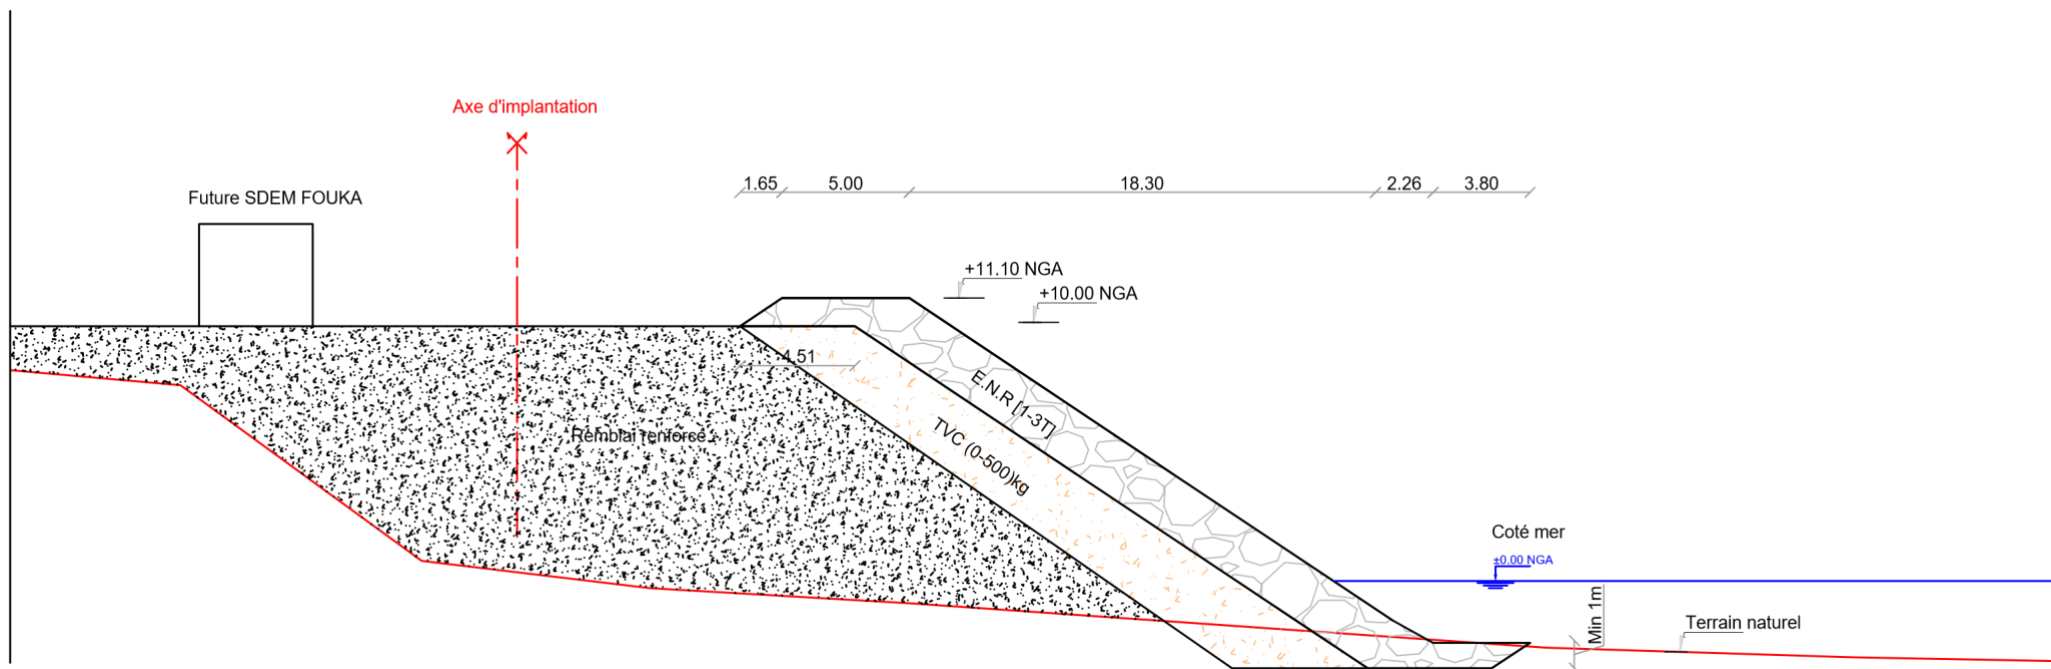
Protection frontale de la station de dessalement - Variante 01 Coupe- type 01
